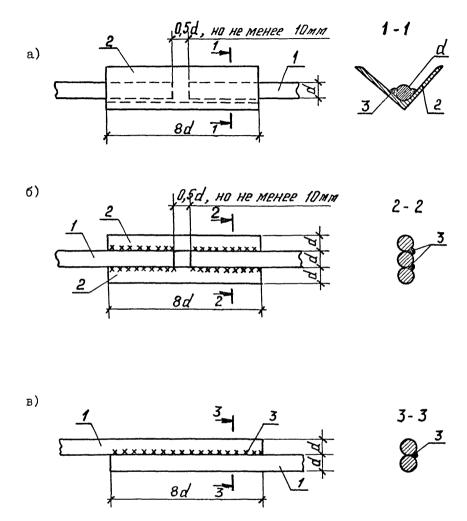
Соединение арматурных стержней на сварке при усилении
